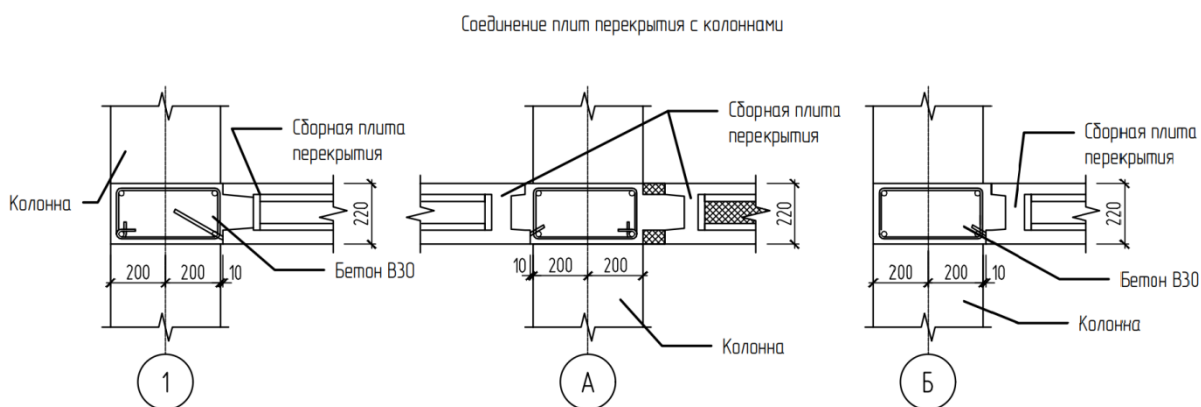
Узел соединения сборных плит перекрытия с колоннами
